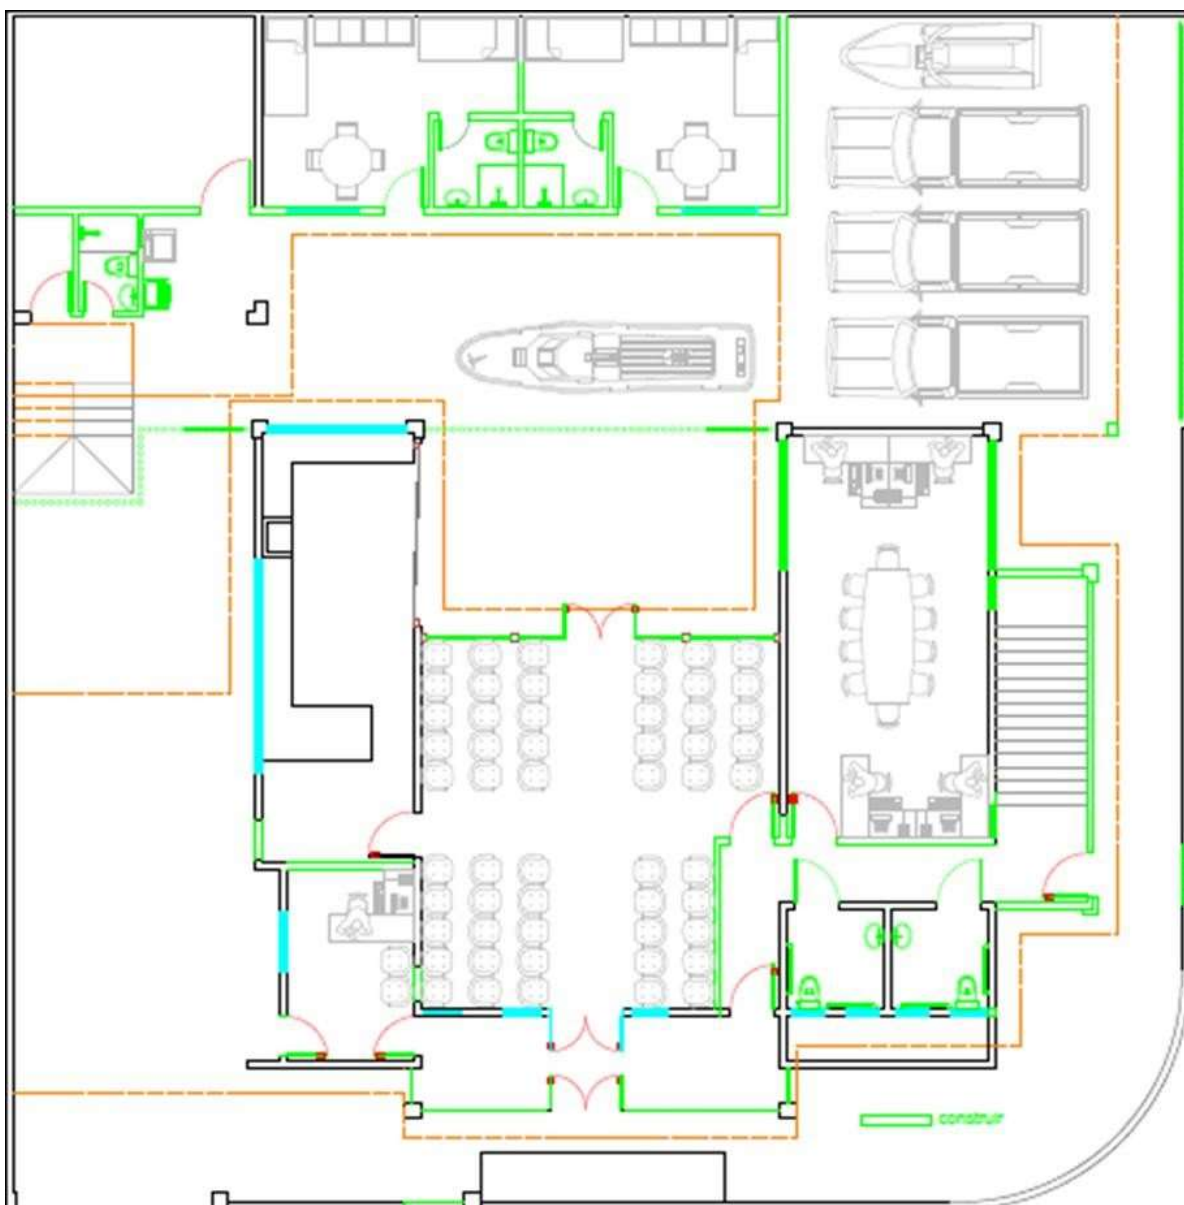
proposta de planta-baixa, humanizada, para o pavimento térreo.
